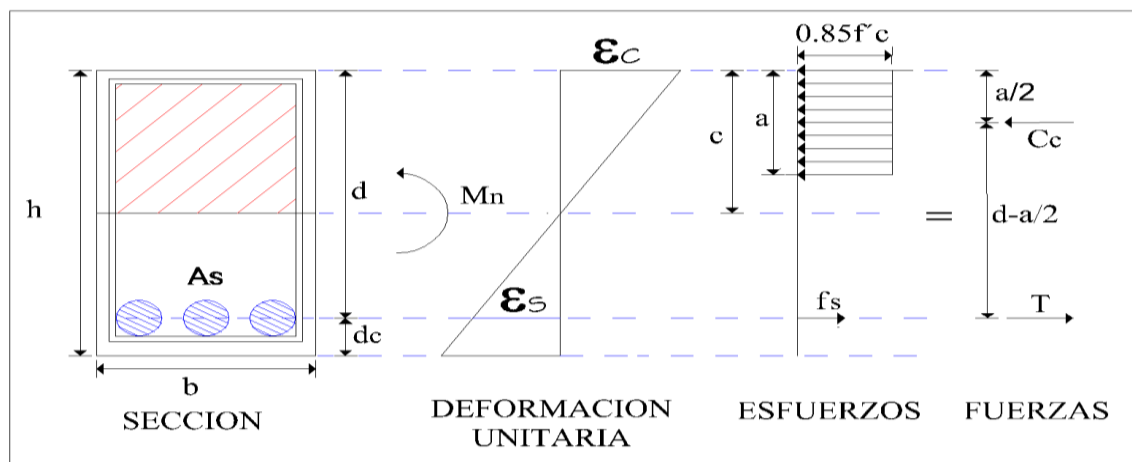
Sección rectangular de concreto simplemente reforzado (Fuente: Figura 3.9. "Diseño de Estructuras de Concreto". Arthur N.)
